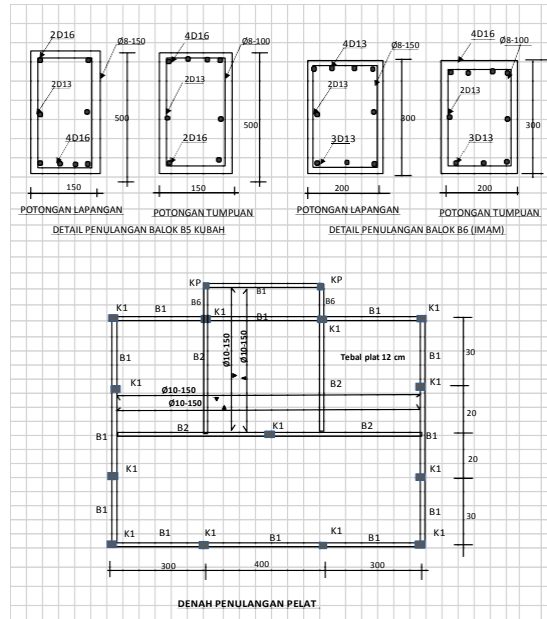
Contoh gambar desain perhitungan balok dan kolom
